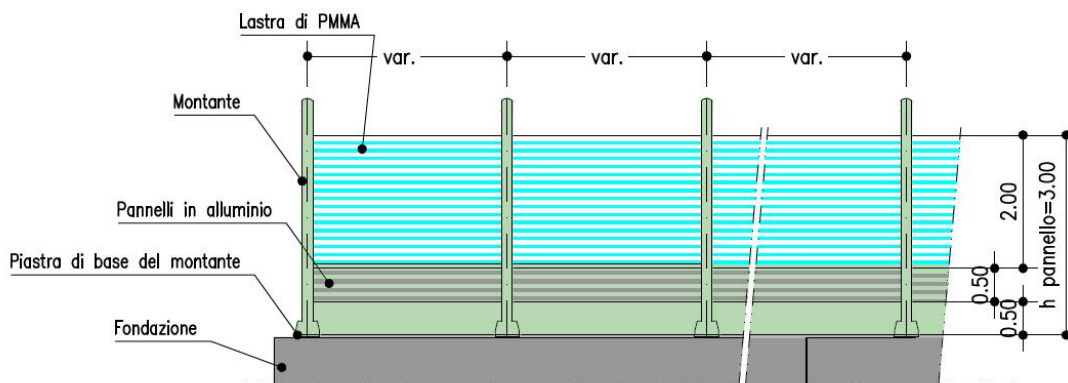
Barriera TRASPARENTE H=3m – Prospetto lato ricettore
